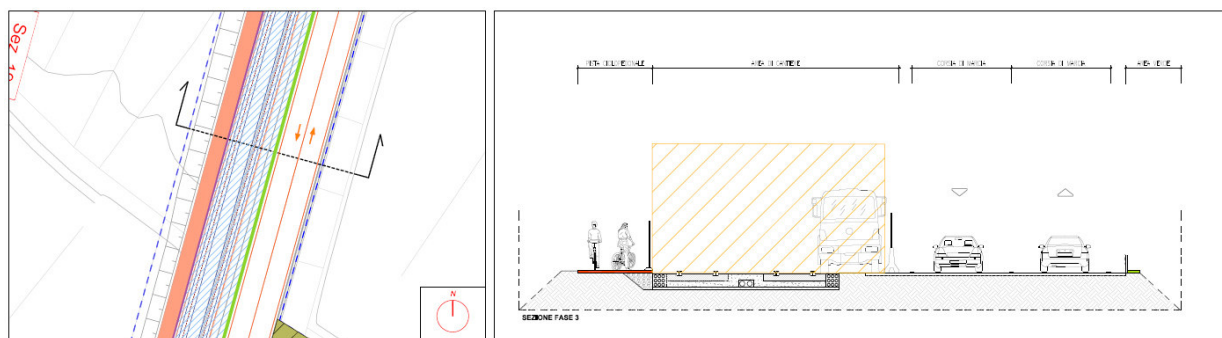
Tipologico cantiere in prossimità di strada Fase 3
